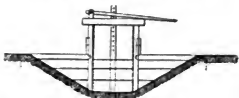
Aufziehvorrichtung mit einarmigem Hebel.
